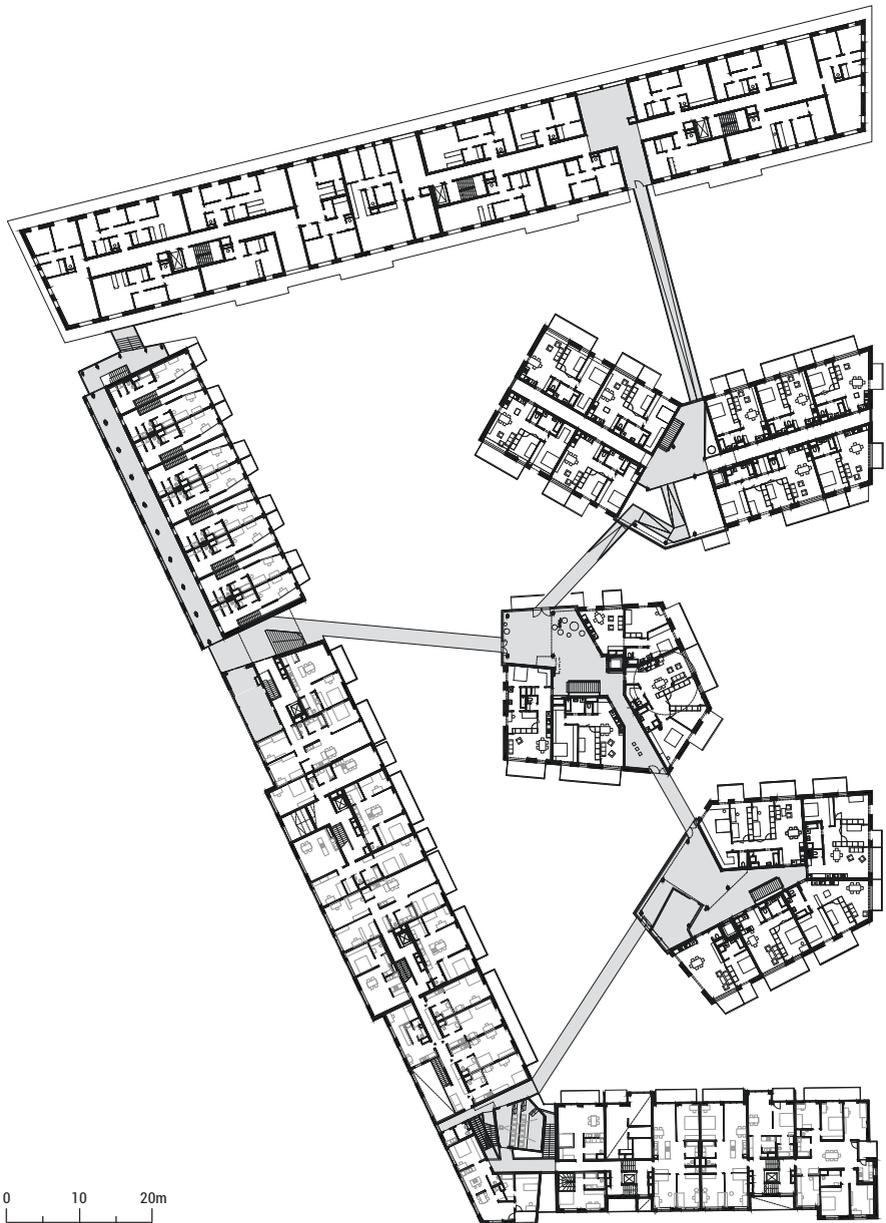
Projekt *Wohnzimmer* im Wiener Sonnwendviertel. Plan: StudioVlayStreeruwitz, CC BY-SA.
